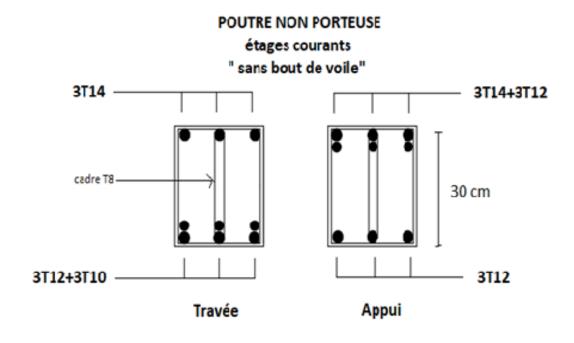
ferraillage des poutres non porteuse Etage Courant sans bout de voile.
